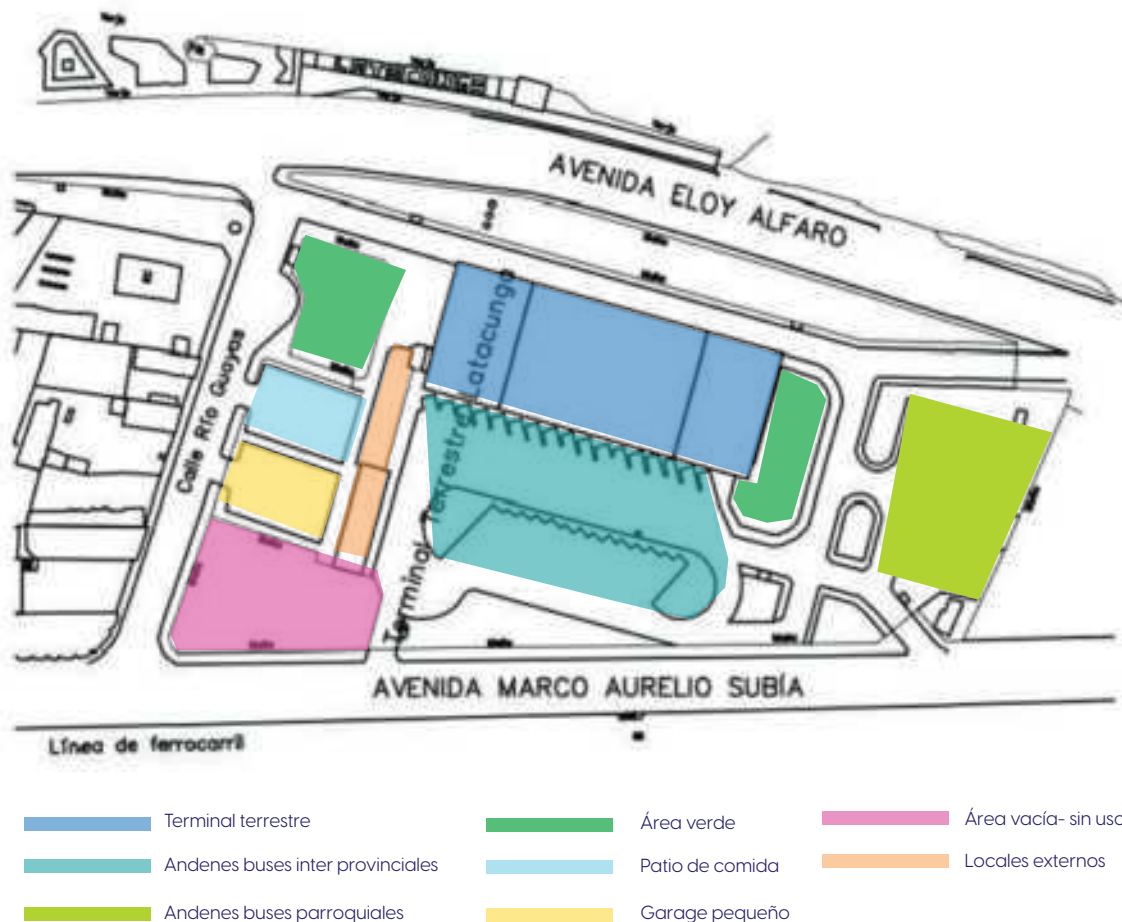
Planimetría actual- Terminal terrestre de Latacunga
